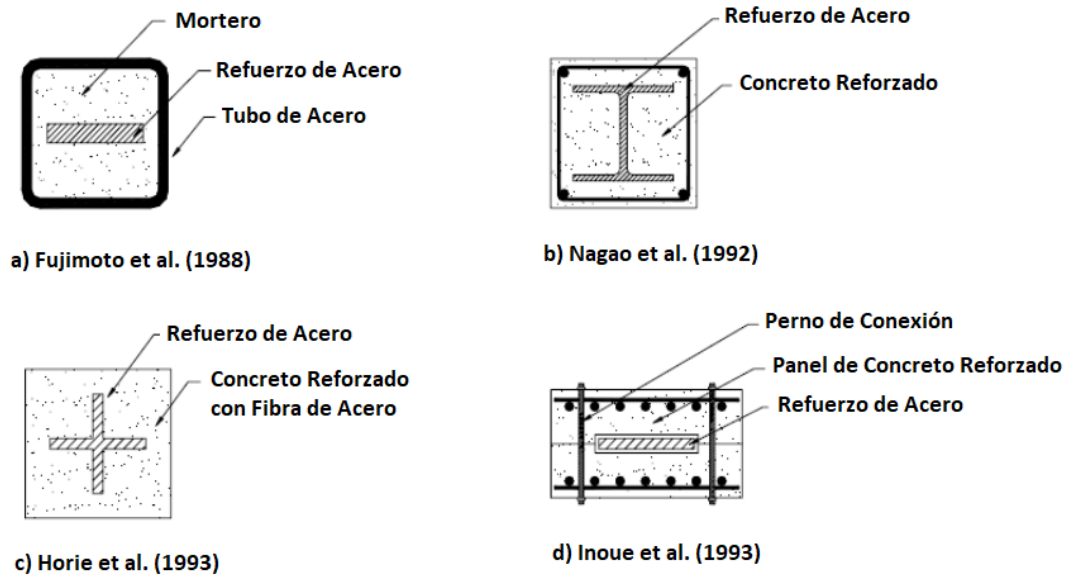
19 Tubo de acero para revestimiento de hormigón BRB
